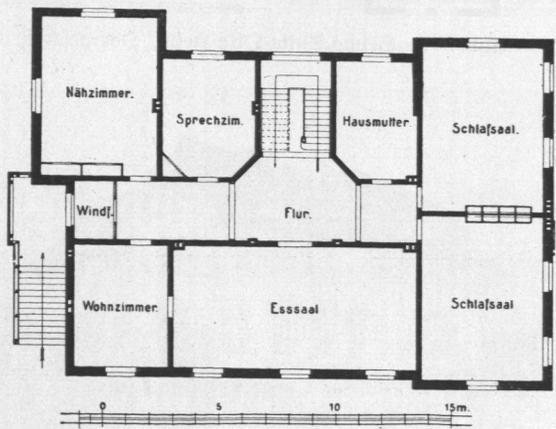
Annaheim, Erdgeschloß, Grundriß.
